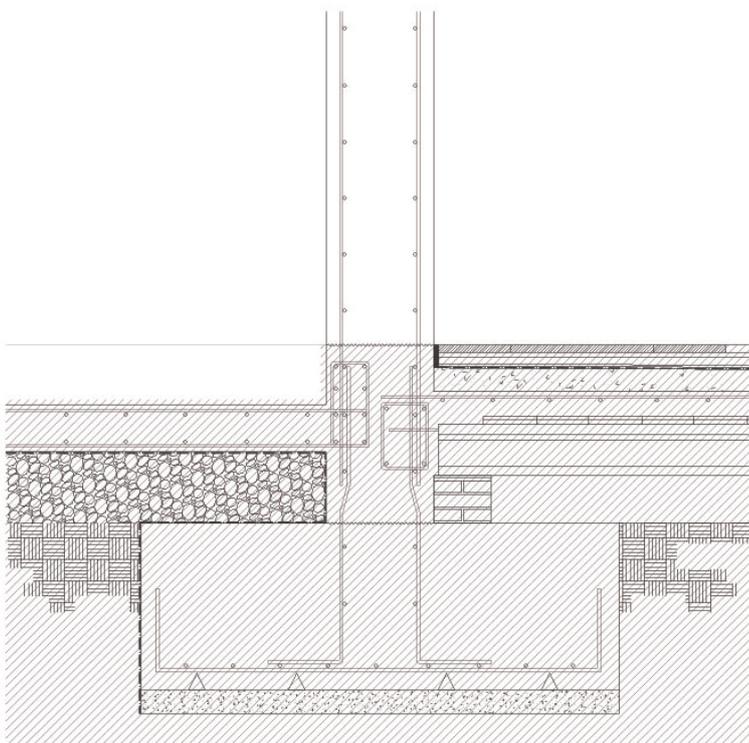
Detalle Encuentro Zapata cuadrada con Forjado y Losa estanque
